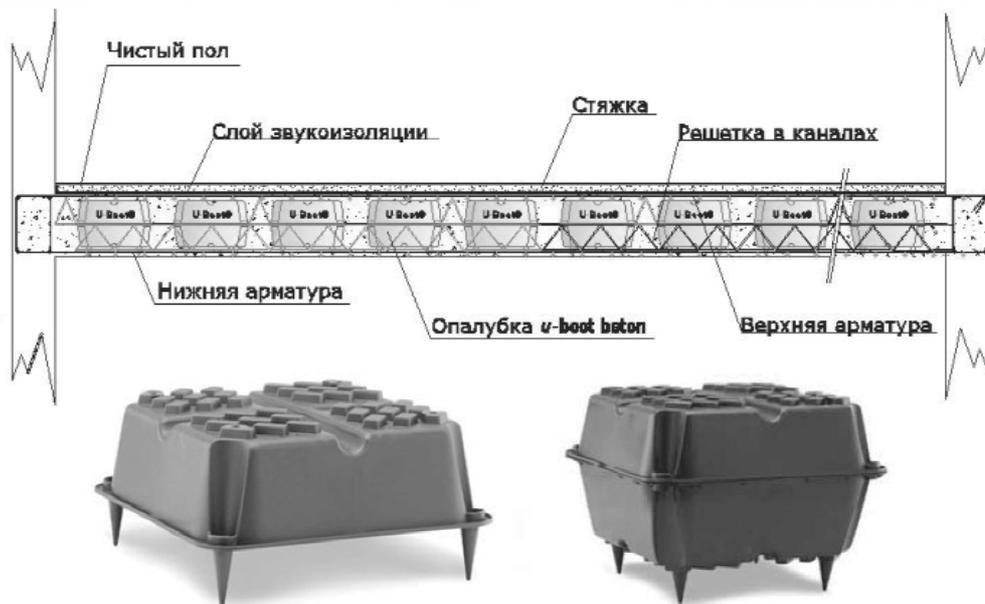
Устройство монолитного перекрытия при помощи системы U-Bootbeton
